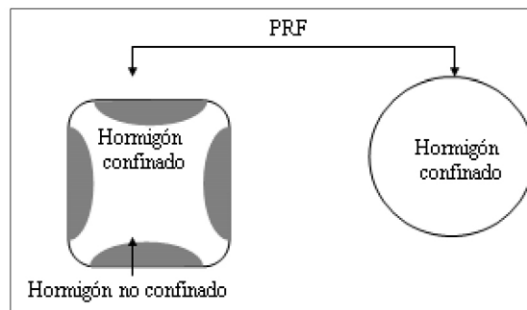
Efectividad del confinamiento con PRF: columnas de sección cuadrada y columnas de sección circular (Al-Salloum, 2007)
